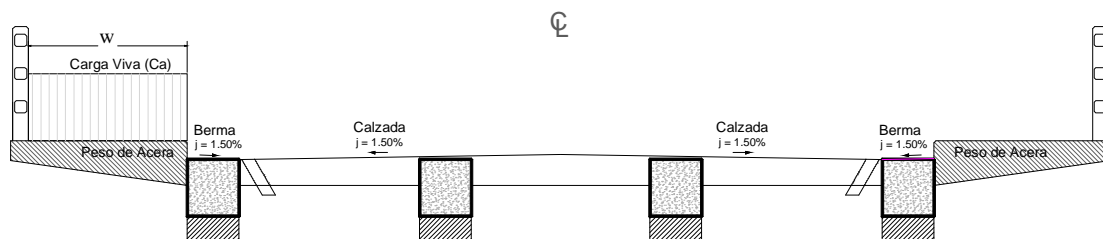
Corte transversal del puente: AUTOR Pedro Hurtado L.
